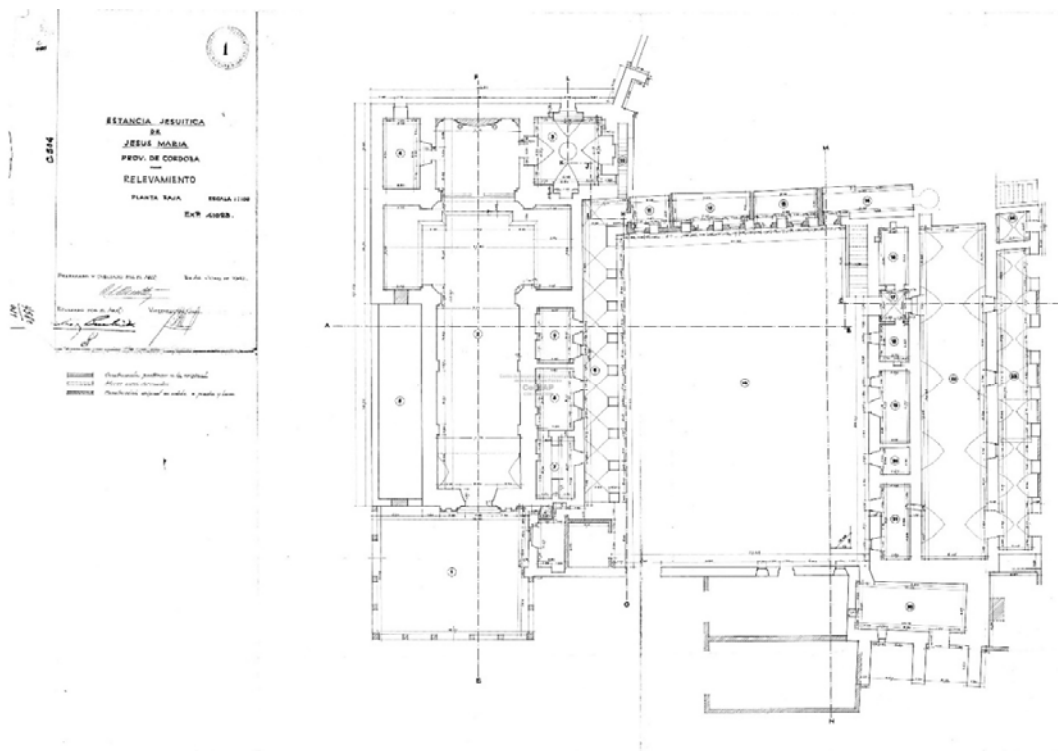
Plano del Relevamiento Estancia de Jesús María. Planta Baja. Autor: Arq. Carlos Onetto.
